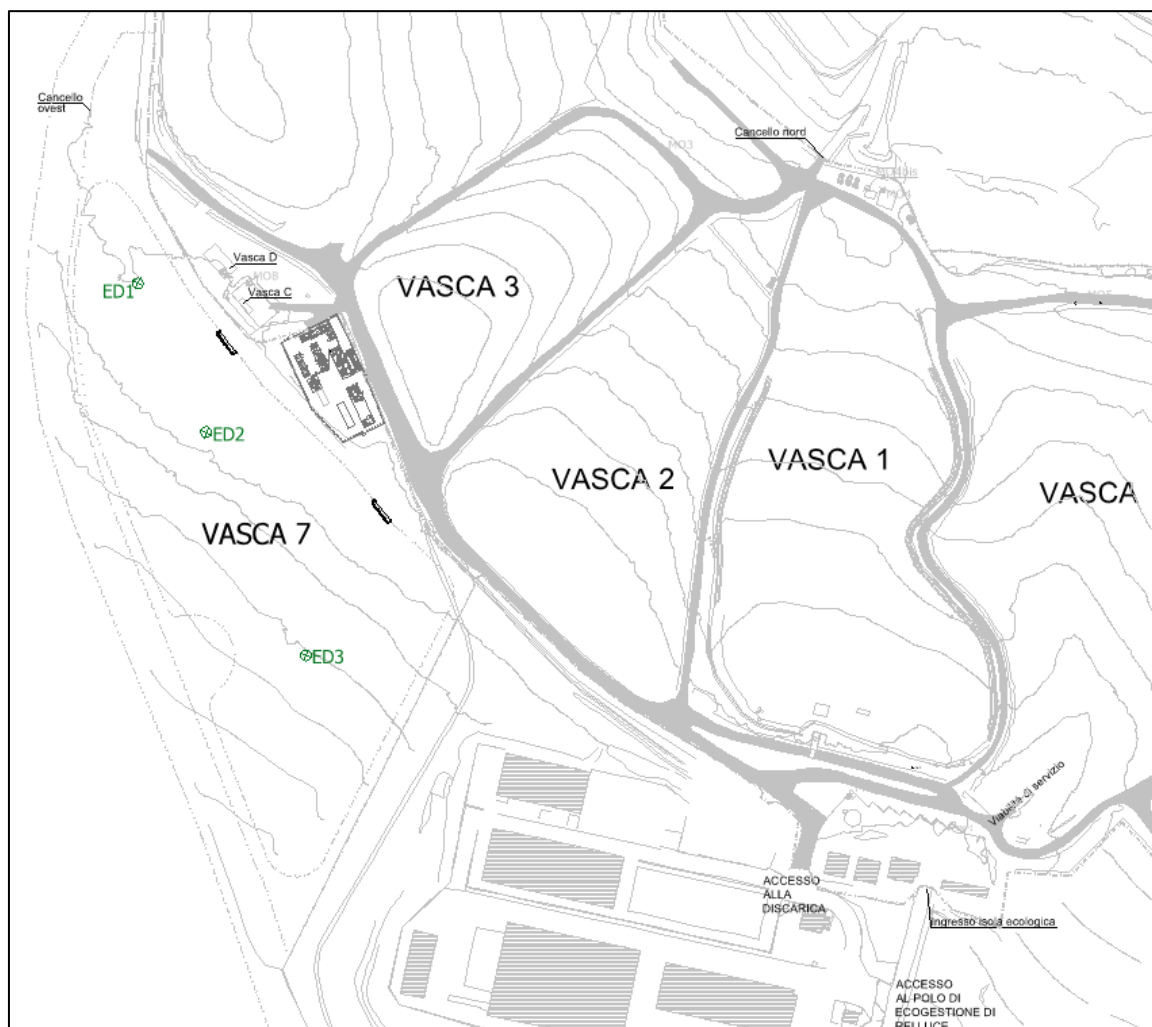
Stralcio planimetrico emissioni diffuse di metano
